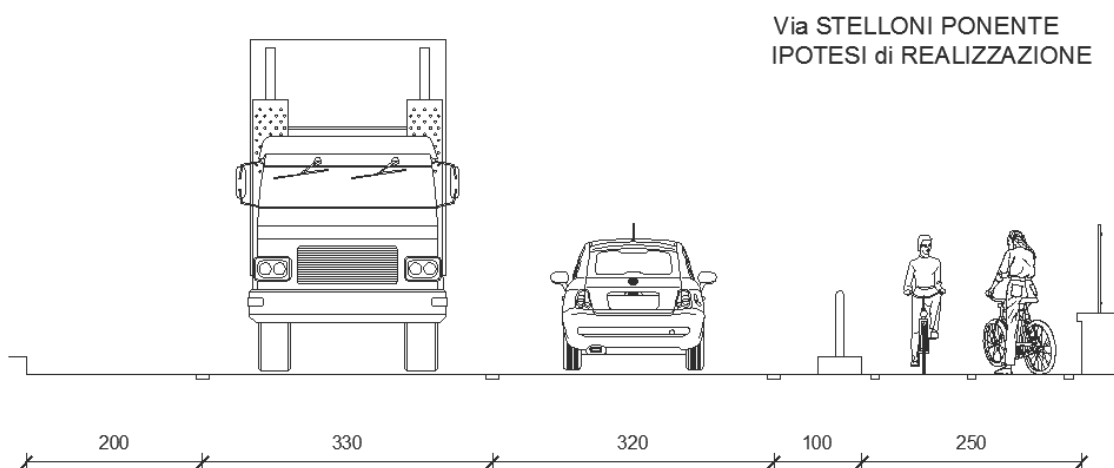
Via Stelloni Ponente – Seconda sezione tipo
